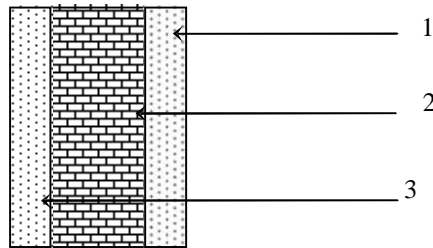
Coupe verticale d'un mur extérieur.
